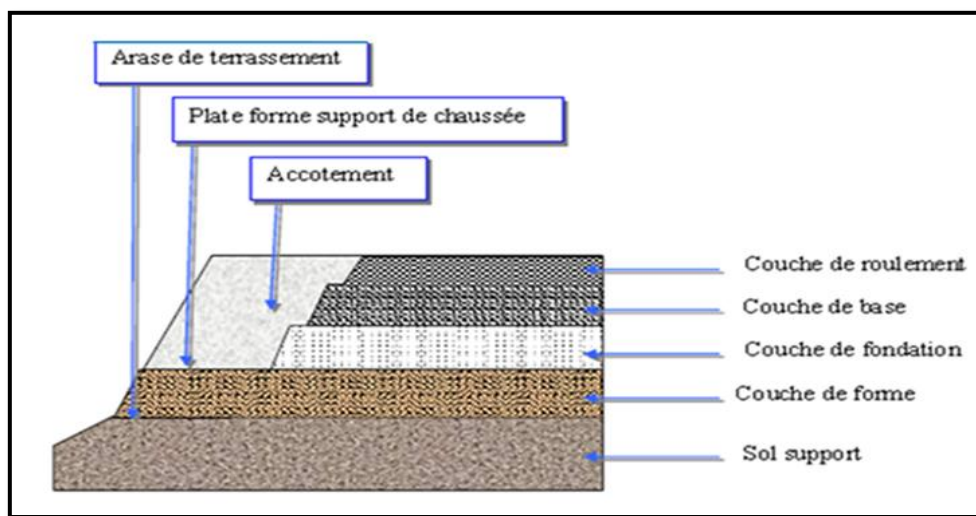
4:Constitution d'une structure de chaussée type [11]
